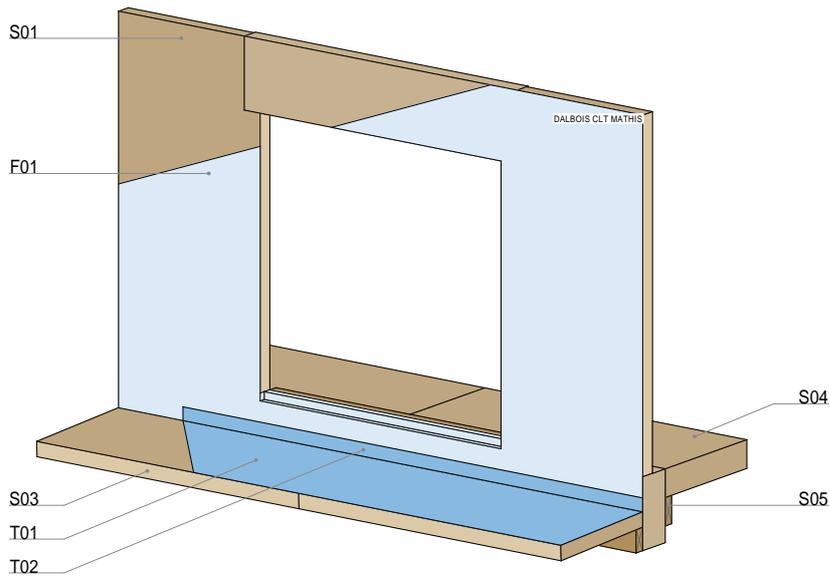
Exemple de traitement d'un relevé avec des CLT DALBOIS CLT-M en configuration de toiture inaccessible isolée sur bâtiment chauffé avec isolation support d'étanchéité (les cotes indiquées sont des cotes minimales)
